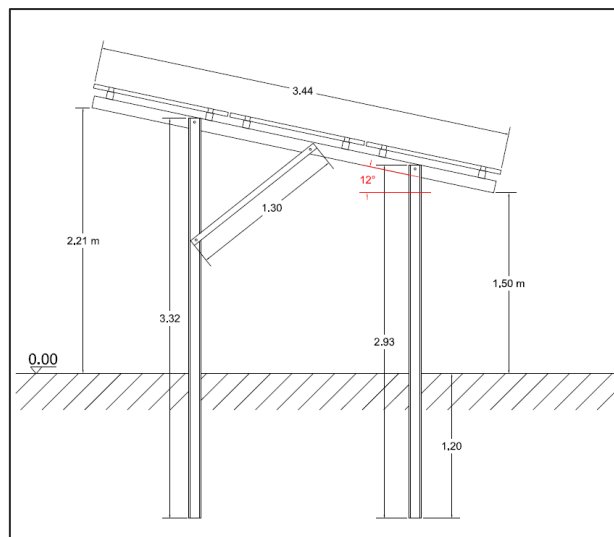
SCHEMA TIPO STRUTTURA FISSA PROPOSTA
